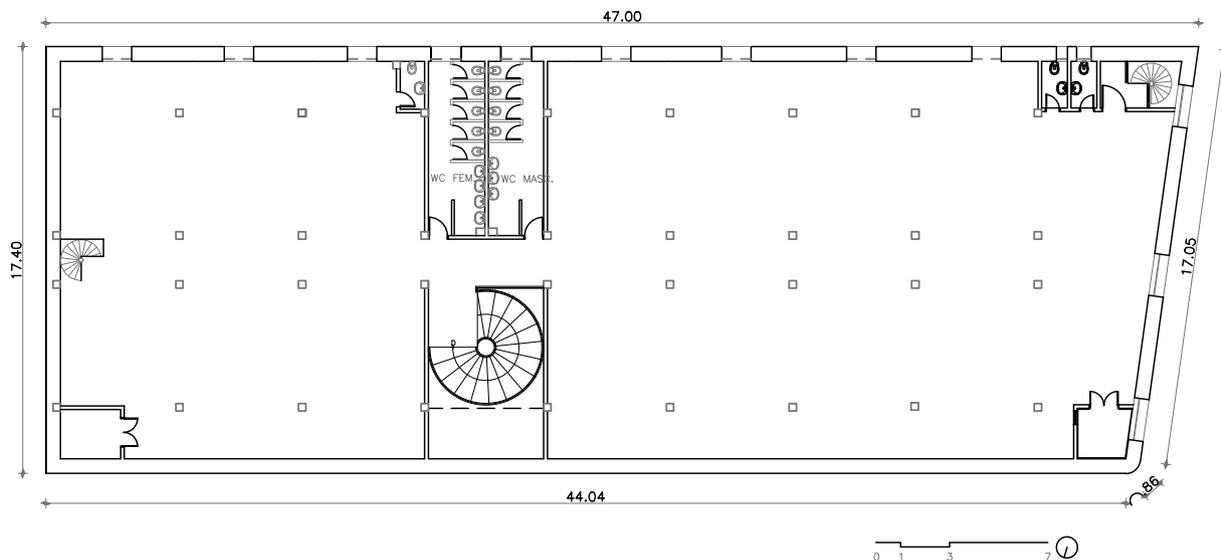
Planta baixa do 1º pavimento do edifício. Fonte: SEINF – SEFAZ/CE.
